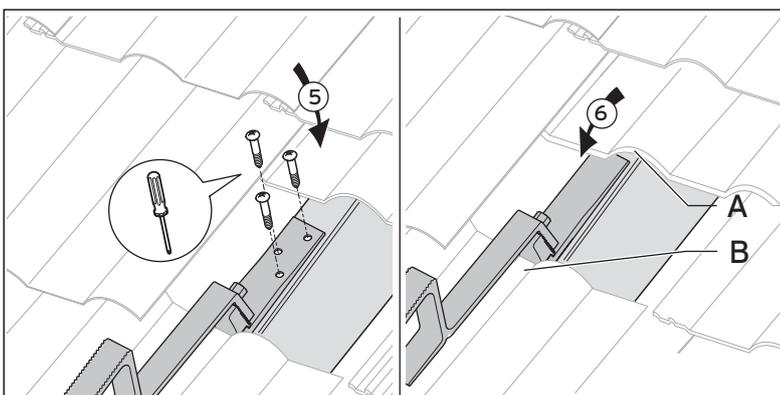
Dachanker Typ P auf dem Dachsparren befestigen
